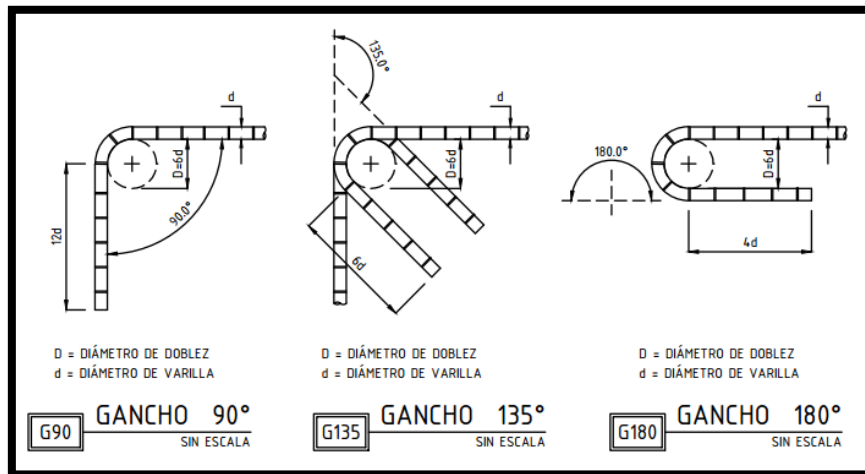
Ganchos de doblado para el acero de refuerzo (Hoja E03, Planos estructurales)
